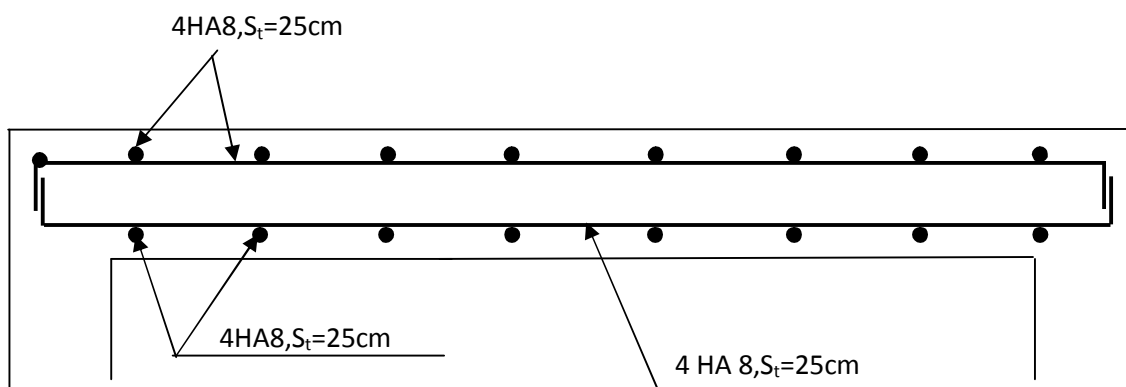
b) Plan de ferrailage de la salle machine suivant y-y.
